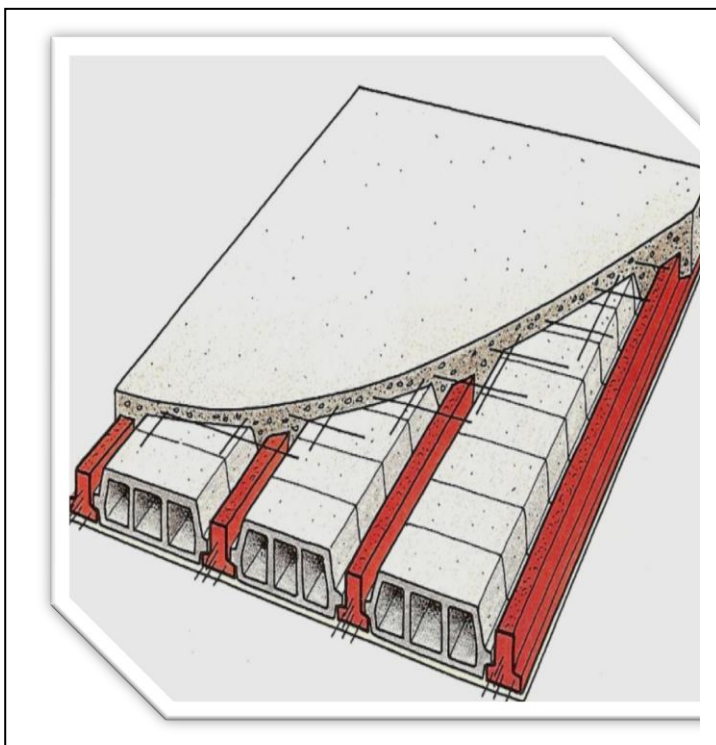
Coupe verticale d'un plancher en corps creux
